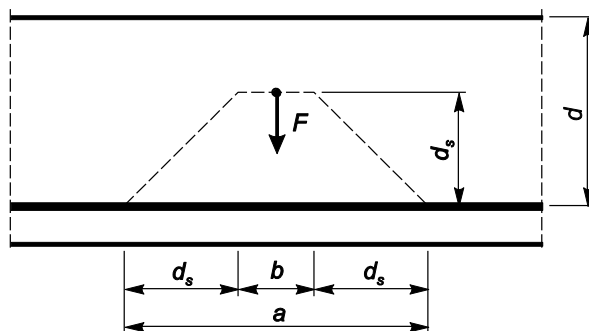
Схема для расчета железобетонных элементов на отрыв
